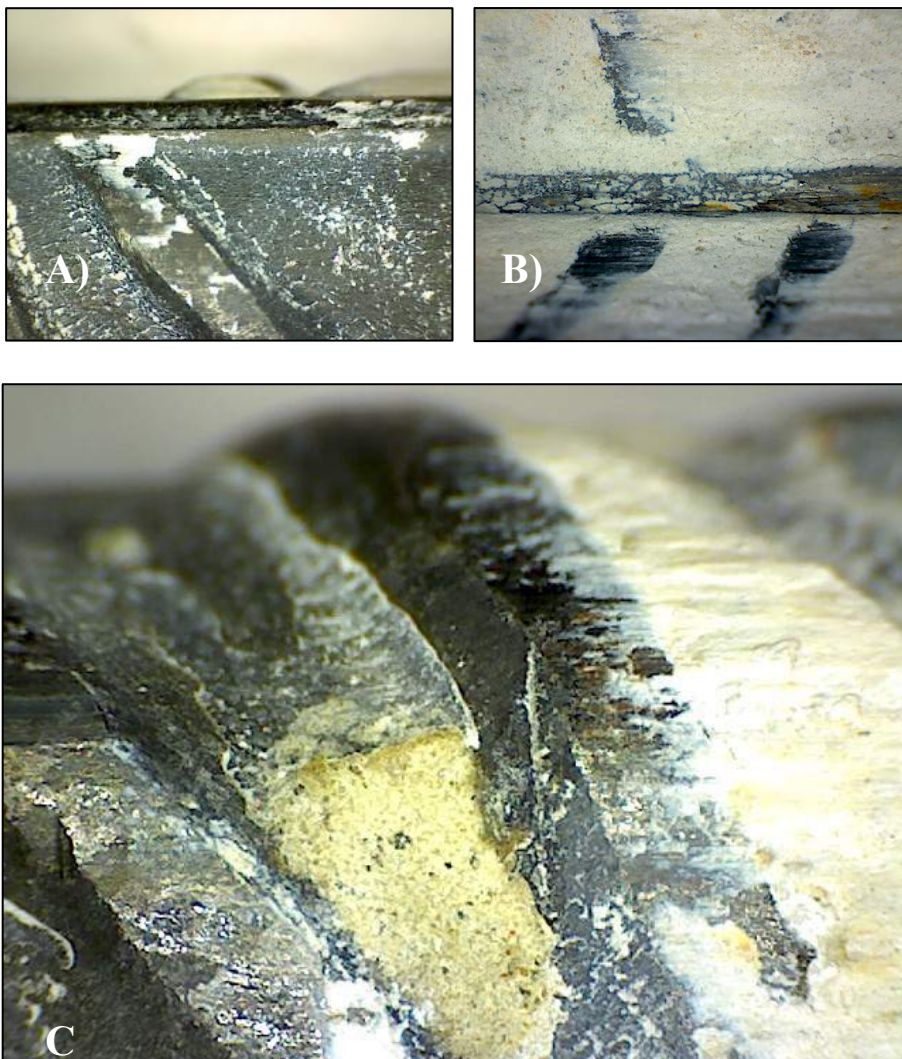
Barra de Acero ensayada a 28 días y a 20° C. A) Zona entre corrugas sin restos de hormigón adherido, B) Zona entre corrugas totalmente colmatada de hormigón y C) Zona de corrugas con y sin hormigón adherido.
